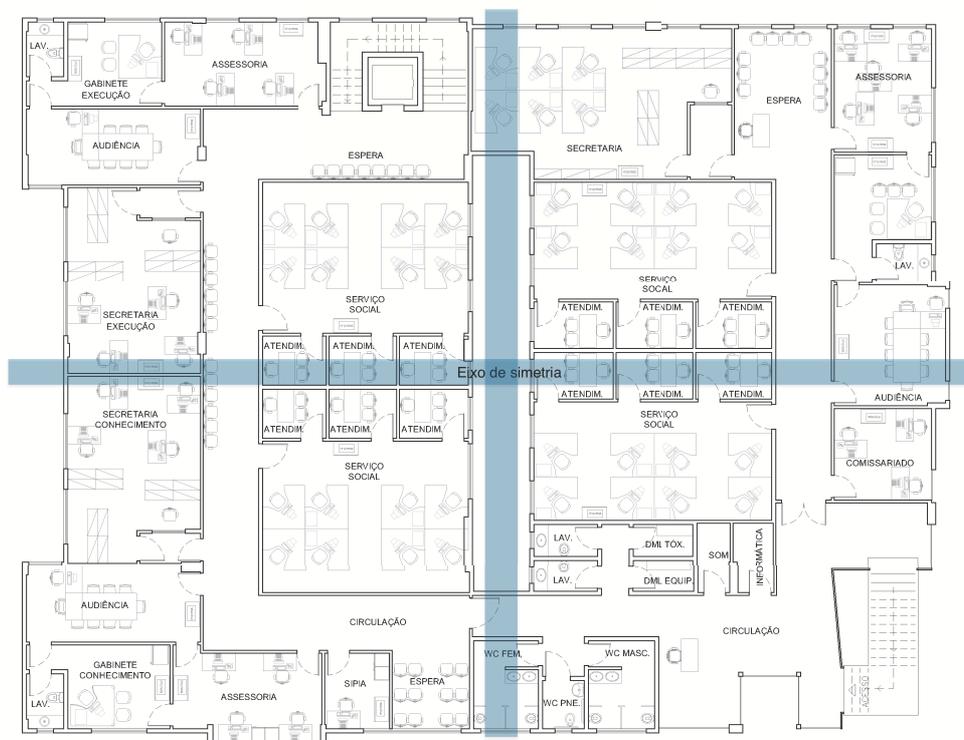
Planta baixa do pavimento destinado a VIJ TIPA. Fonte: arquivo pessoal.
